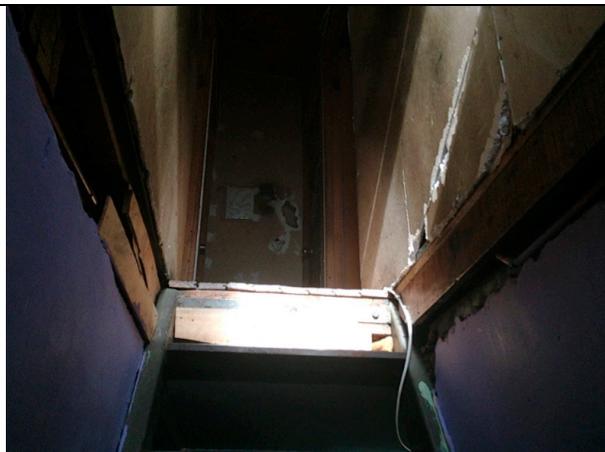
Escalera de acceso a segundo piso. Nótese la falta de terminaciones.
